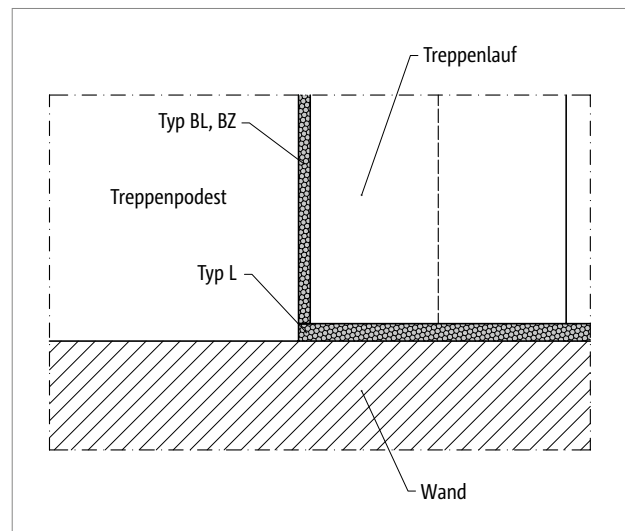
Schöck Tronsole® Typ BL, BZ: Elementanordnung, Detail B
